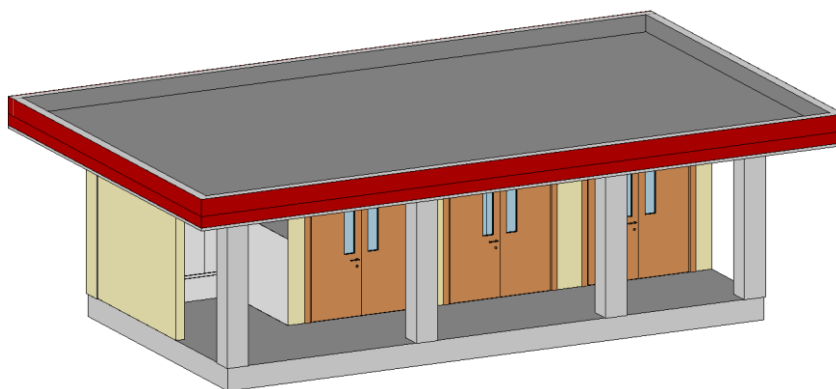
Isometría del modelado arquitectónico 3D del Edificio 03
